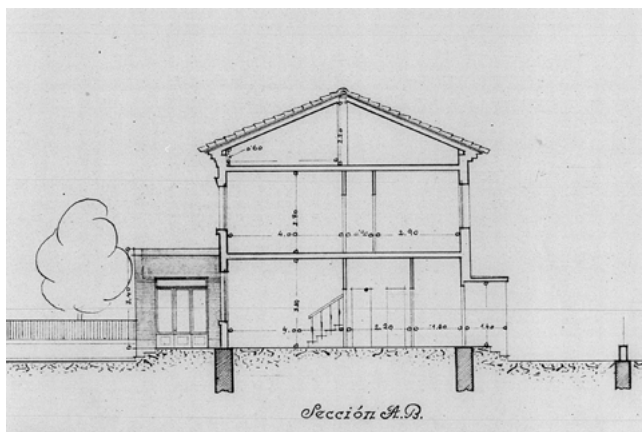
Sección del proyecto de 10 chalets en hilera en la calle San Fernando, obra de Alejandro Allanegui (1940). Fuente: AHPTE_RRDDTP_13653_0001.
